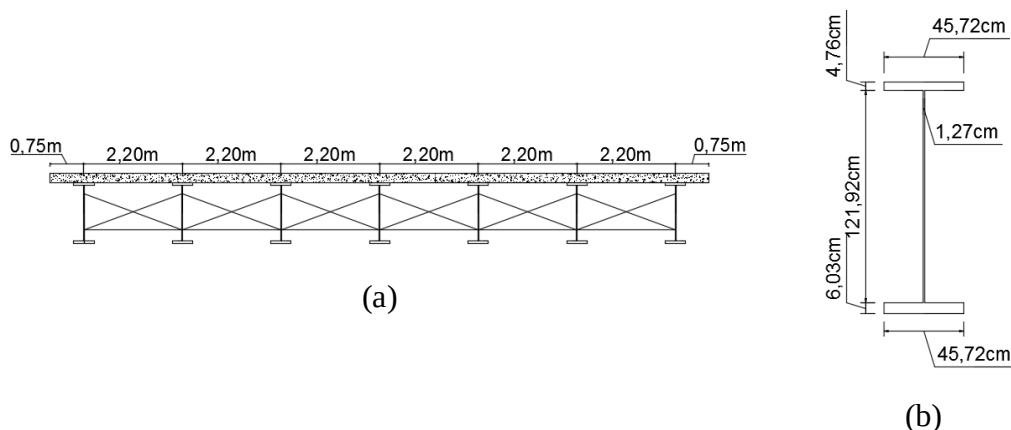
(a) Seção transversal da ponte; (b) detalhe da seção transversal da viga.
